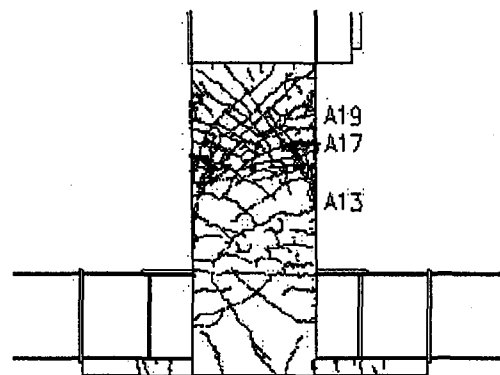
TYPE 1-1 最終時橋脚ひび割れ状況
